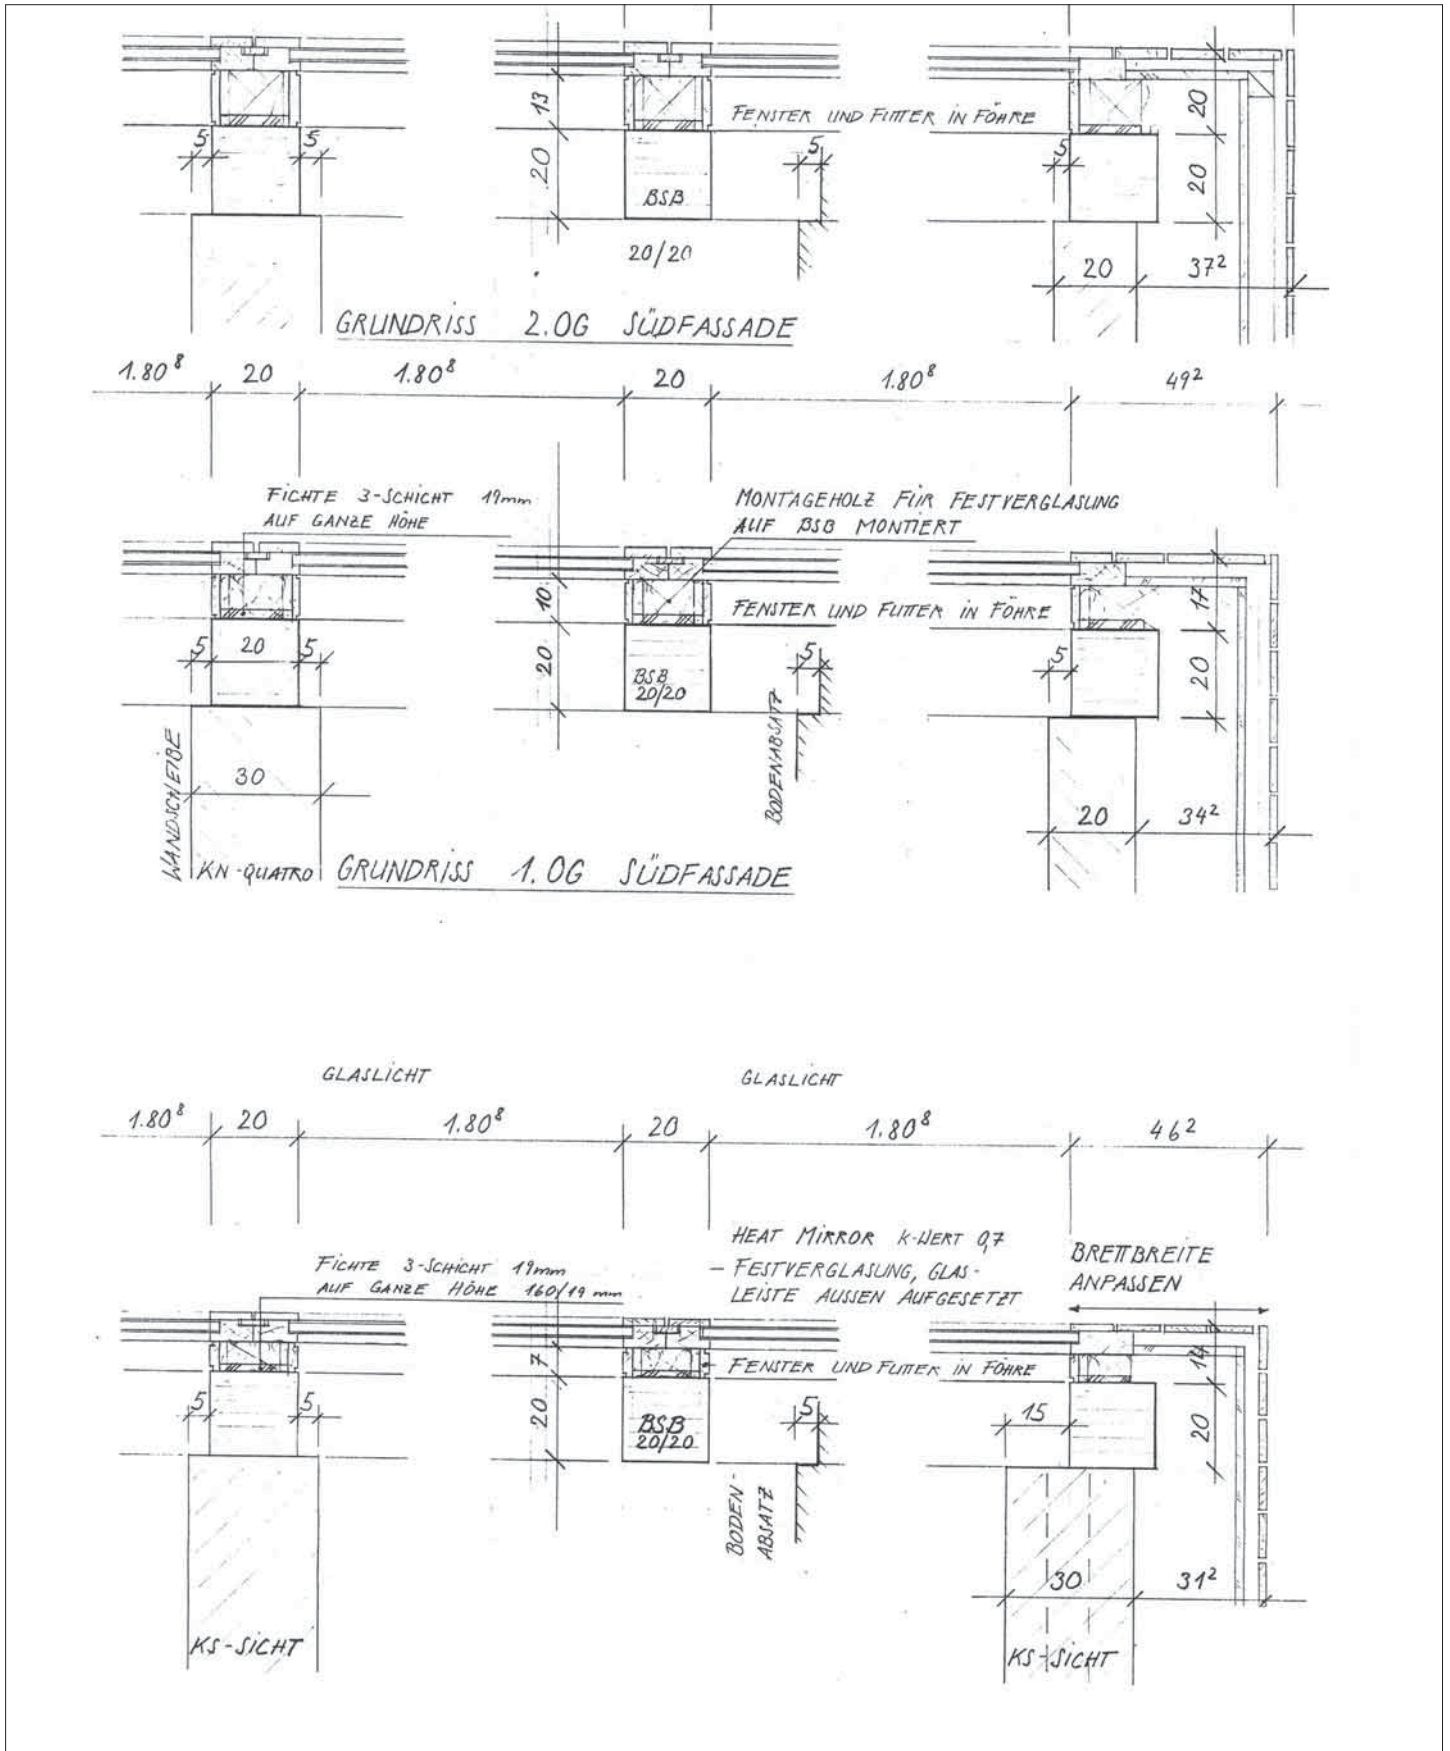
Haus Gasser, Grundriss Südfassade 1. OG (oben) und EG (unten).
